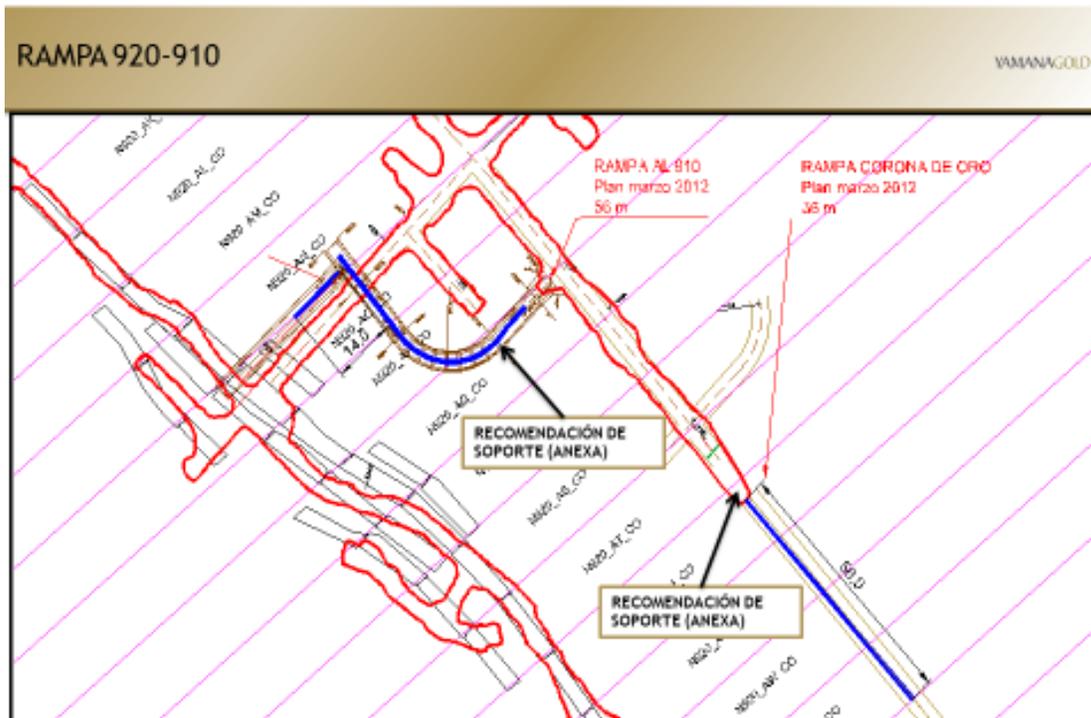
Mina Mercedes. Vista de la rampa central, emergente que fue necesario construir.
